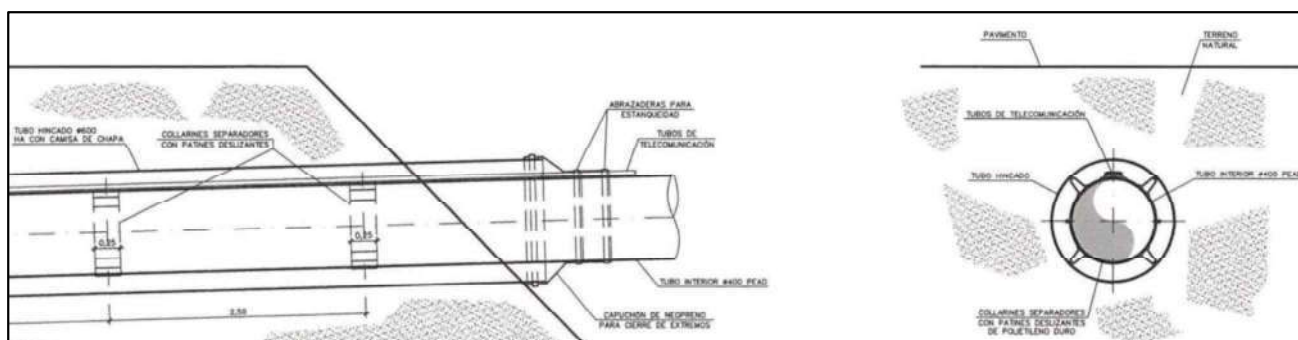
Sección longitudinal y transversal de la tubería (tomado del plano 5.4. de Proyecto).
